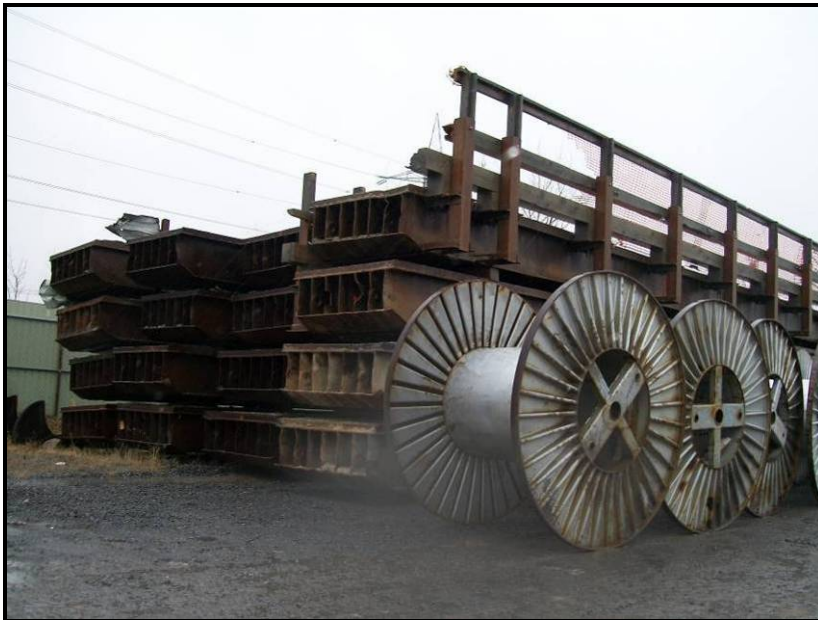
(2009-12-03) : Entreposage de sections de pont temporaire dans la zone d'entreposage n° 95.
